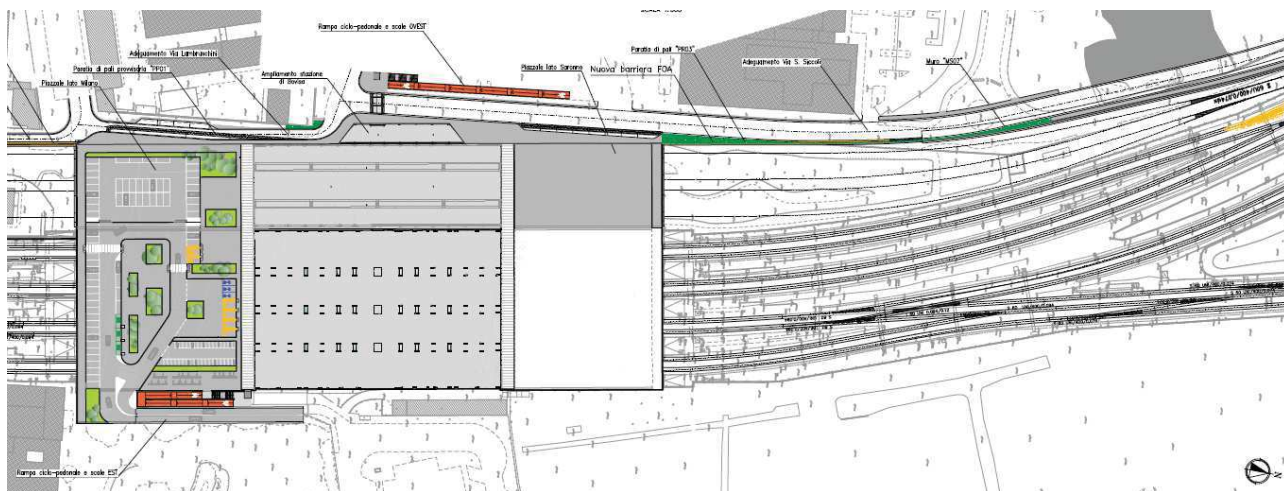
Planimetria di progetto (da FV a radice nord di Saronno)
